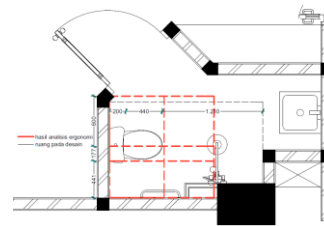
Ruang Gerak Zona Toilet pada Desain
